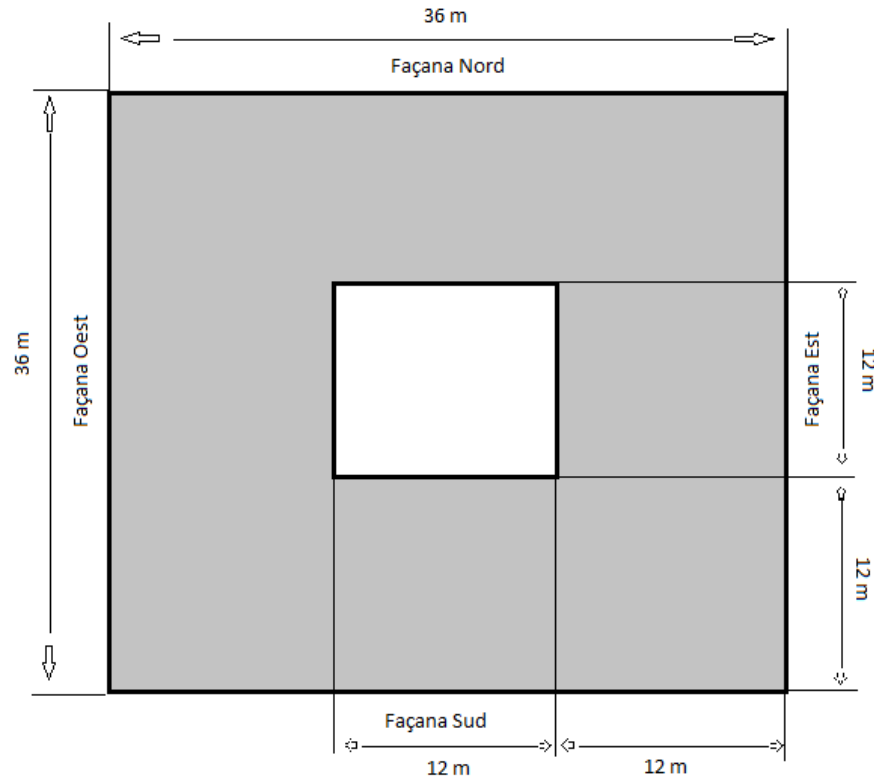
Vista en planta de l'edifici d'estudi.
